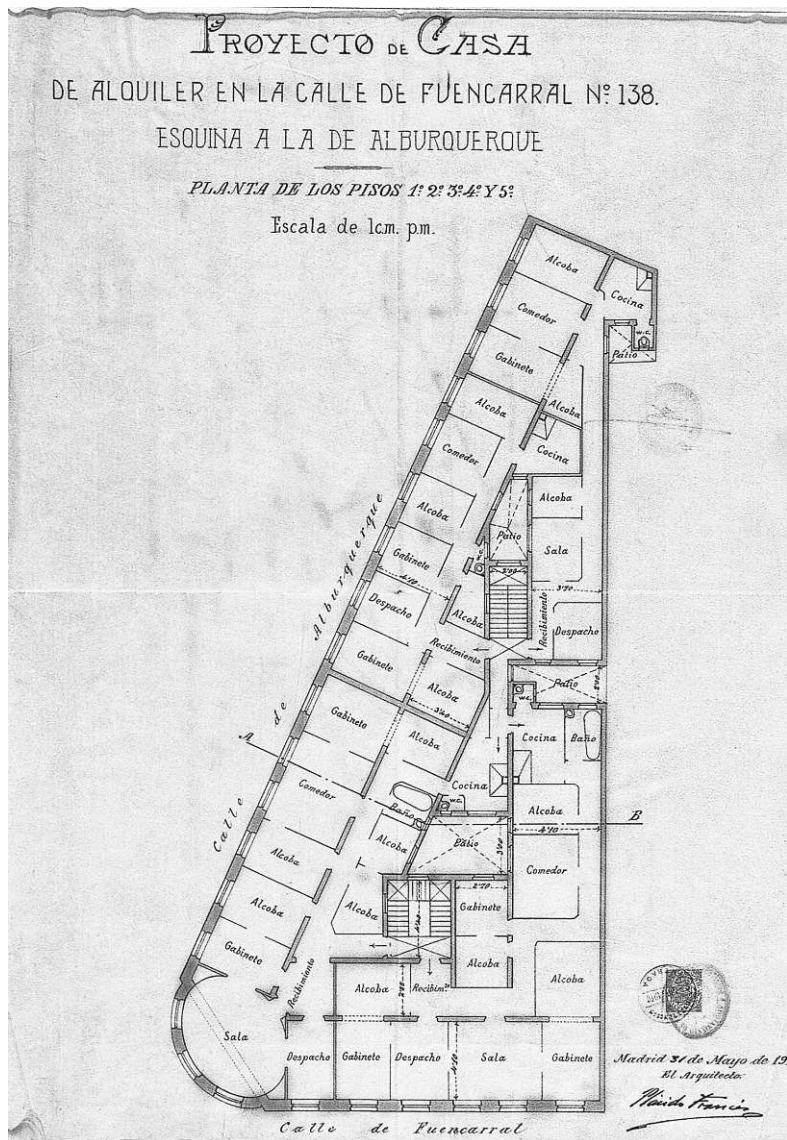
Grundriss der oberen Stockwerke des Wohnhaus für Modesto González in der Calle Fuencarral 132 - Plácido Francés Mexía, 1910
